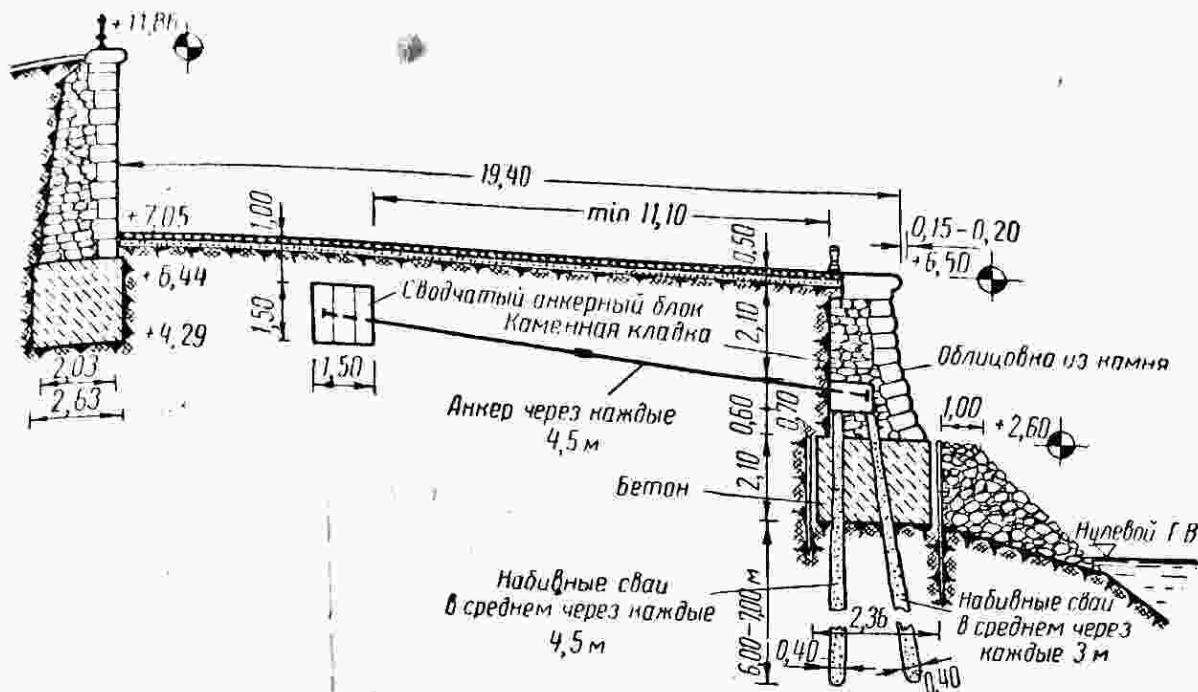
Усиление береговой подпорной стенки перед Главной таможней
